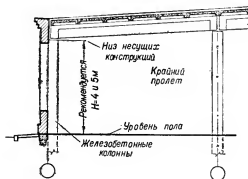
6. Высота крайних пролетов зданий с наружным отводом воды без мостовых кранов.
